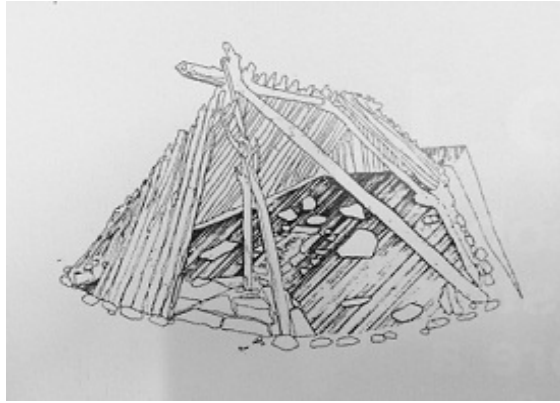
Reconstrução do que seria o primeiro abrigo realizado em betão [3]
